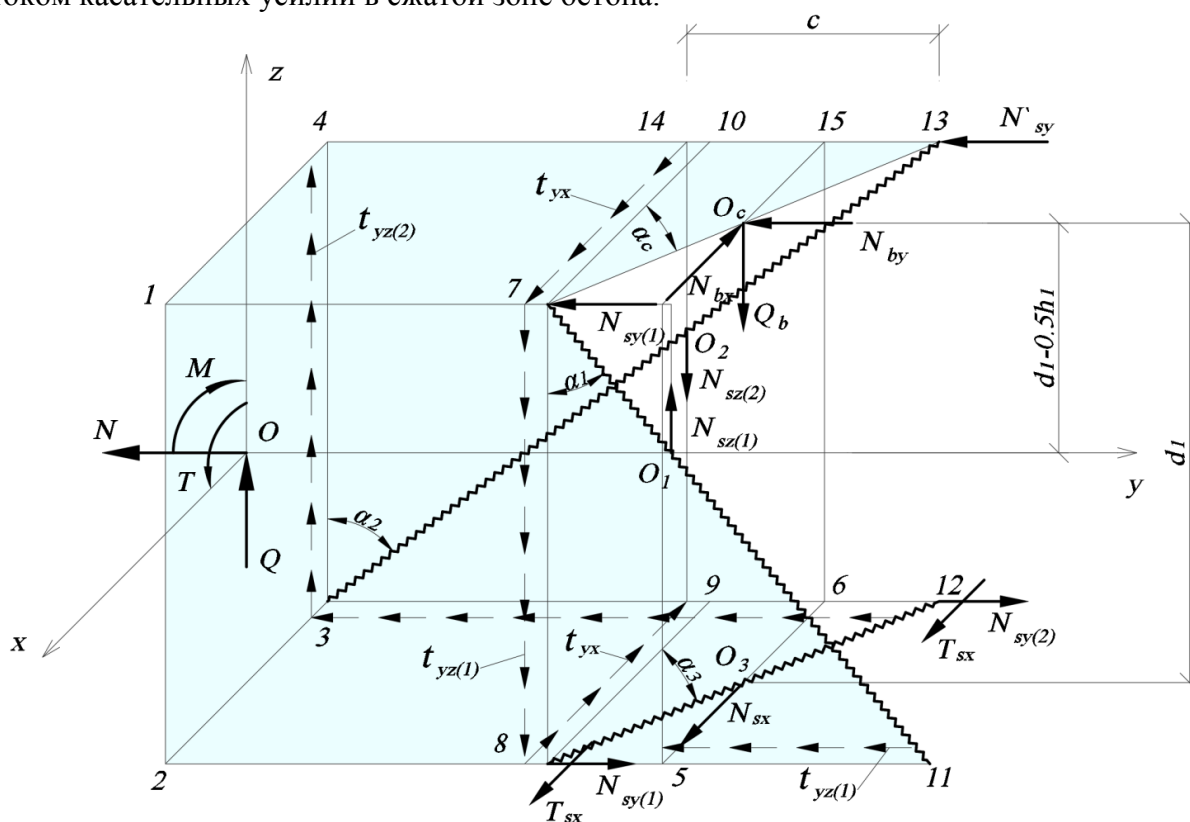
Расчетная схема железобетонного элемента при действии крутящих и изгибающих моментов, поперечных и нормальных сил
